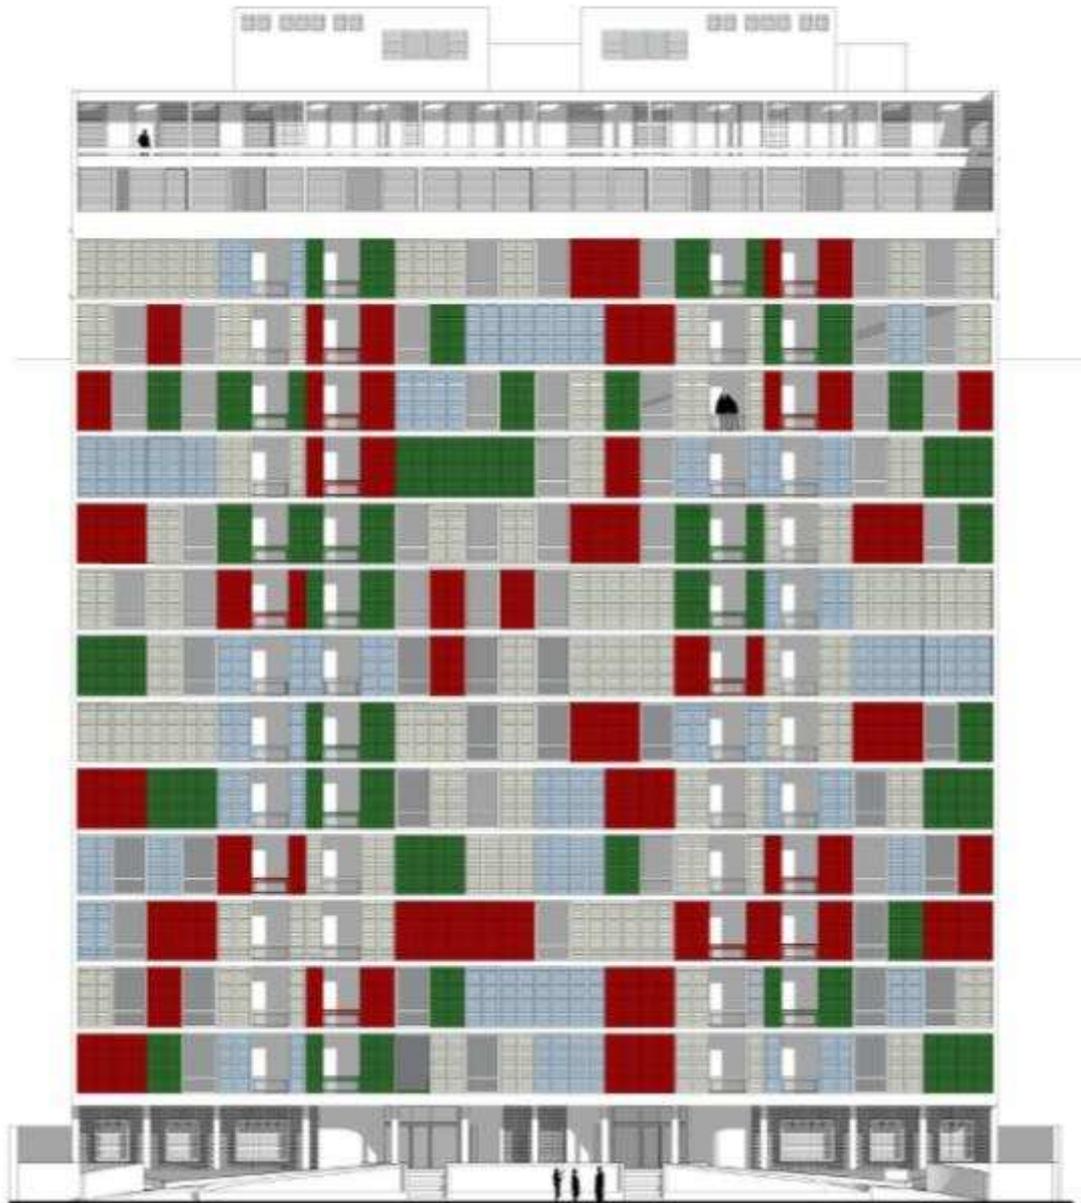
Fachada do Ed. Lausanne (desenho do autor)
